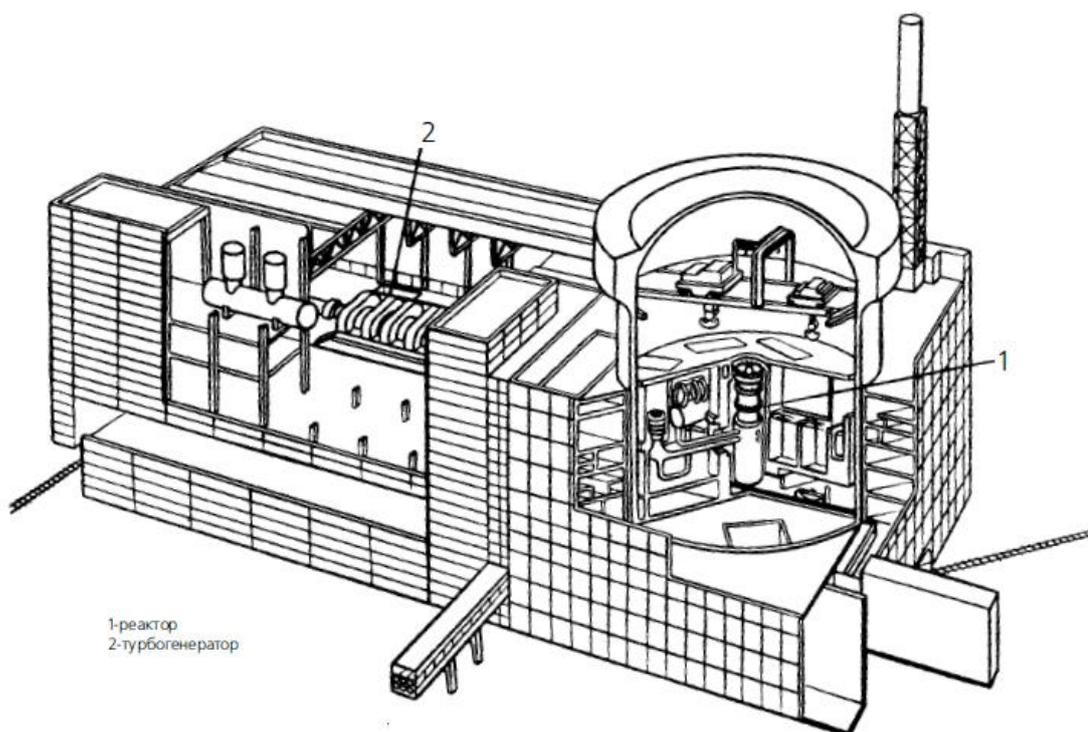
Общий вид главного корпуса Балаковской АЭС с унифицированным реактором ВВЭР-1000
